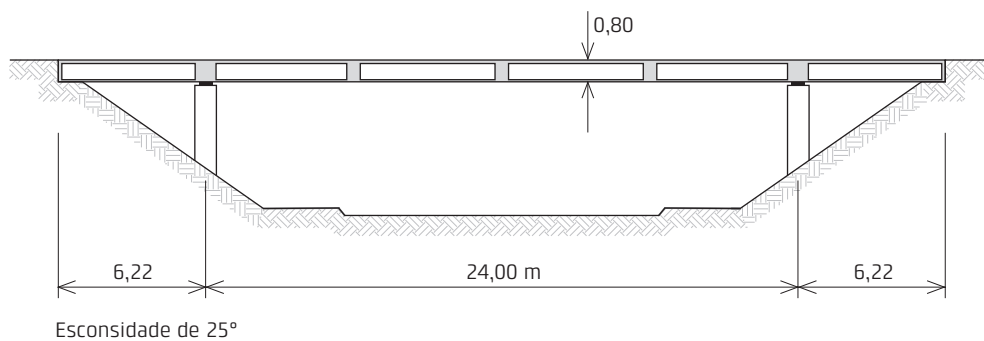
Seções transversais de pontes de laje vazada (adaptado de Martinelli, 1978)
